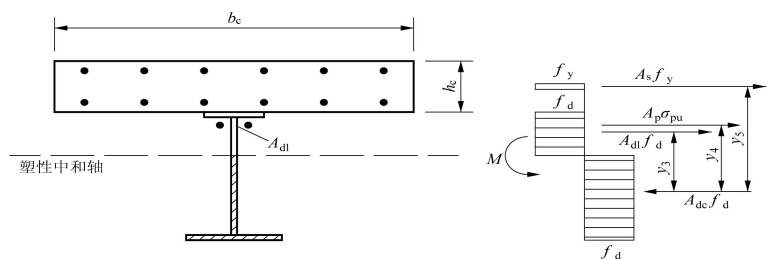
负弯矩作用时的组合梁截面及应力图形
